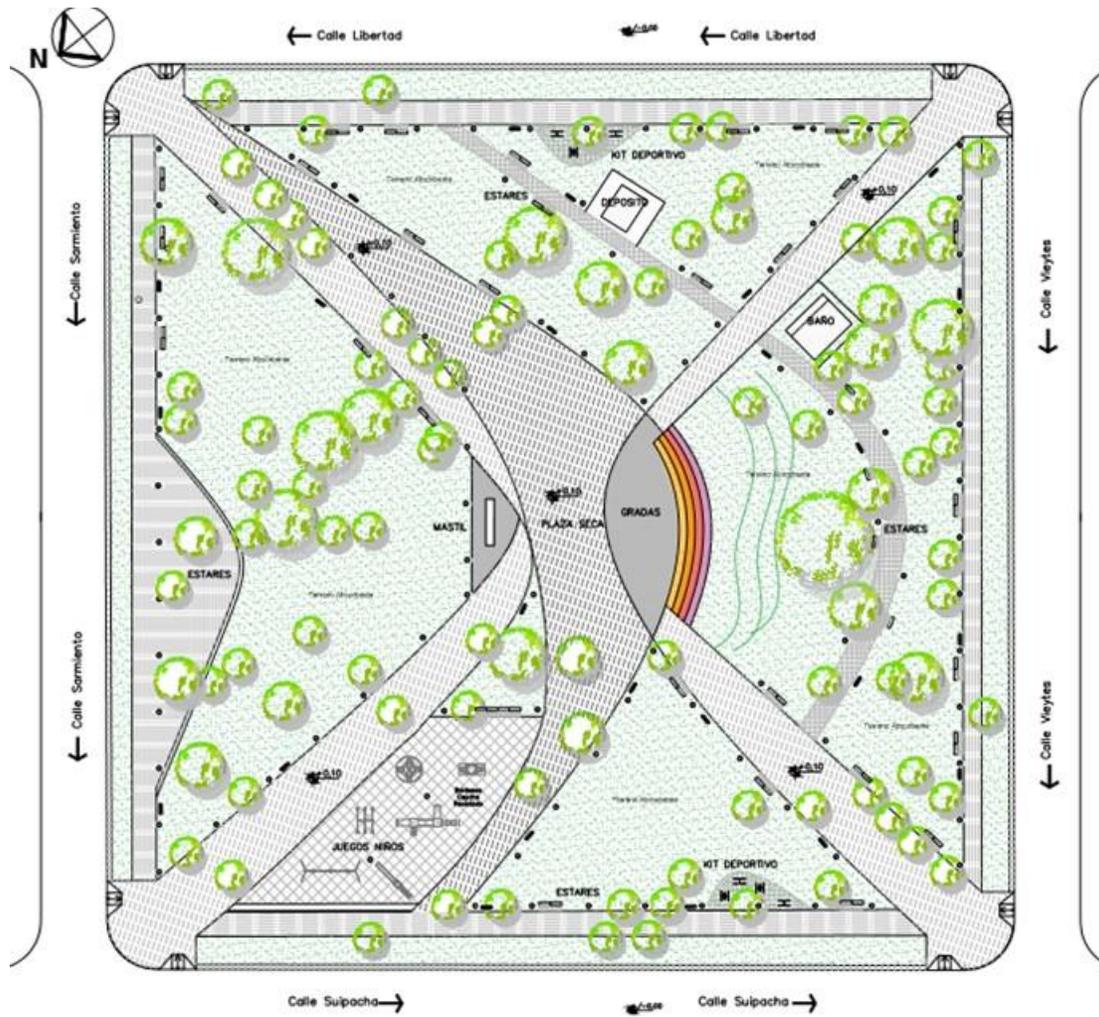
Planimetría General-Fuente: Proyecto de Arquitectura
